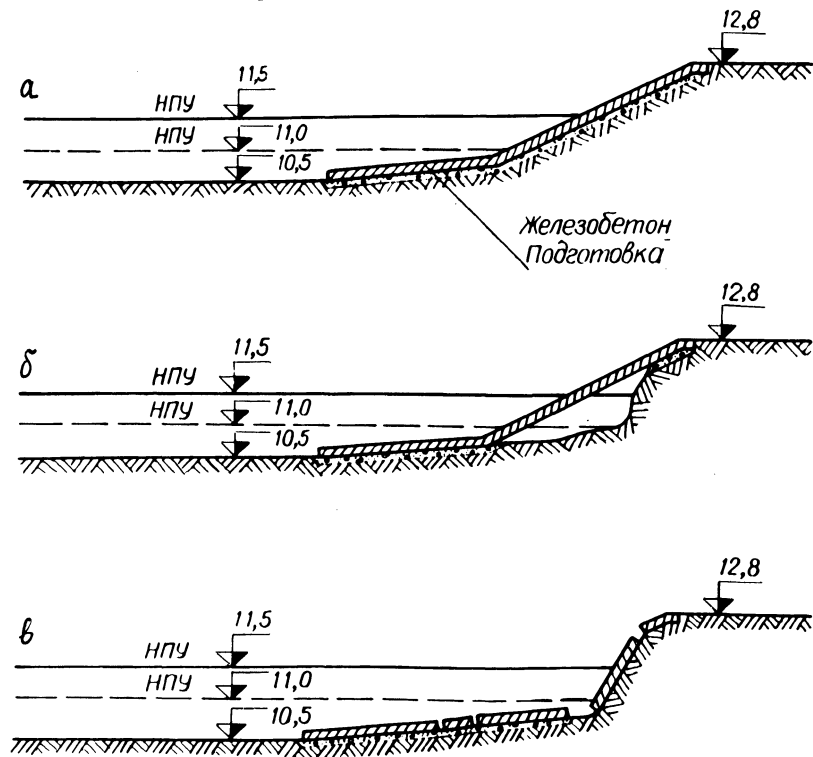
Схема разрушения монолитного железобетонного крепления берега Лепельского водохранилища: а - проектные и построенные в 1964 г.; б - начало разрушения; в - конечная стадия разрушения.
